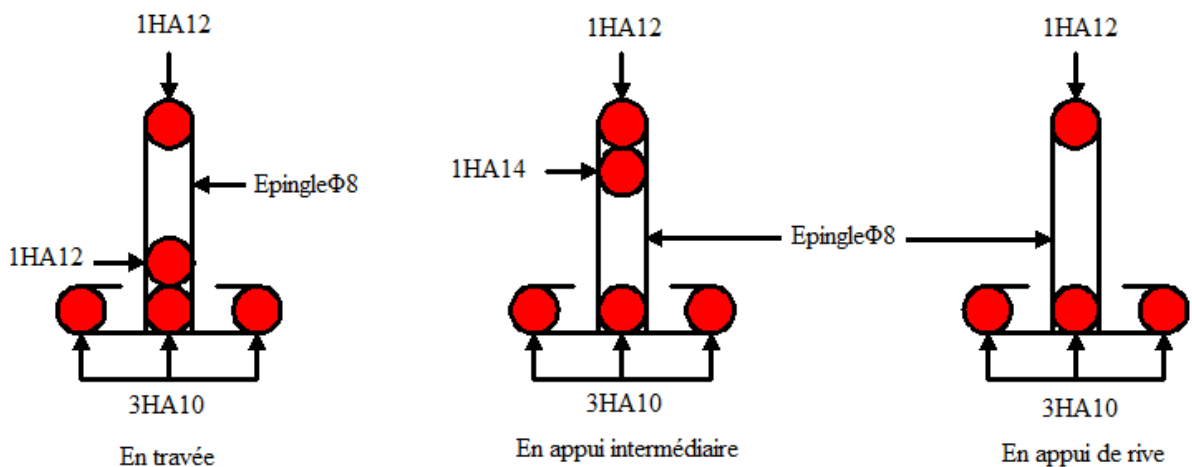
Schéma de ferrailage des poutrelles Sous sol
